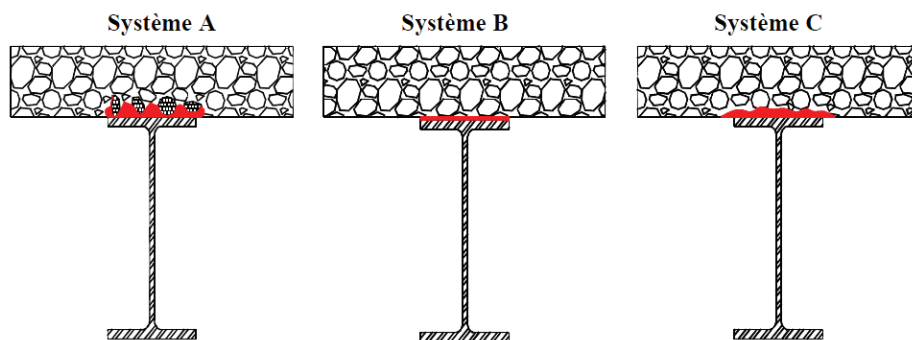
Les trois possibilités d'assembler les poutres mixtes acier-béton [Hertig et Perret, 1973]
